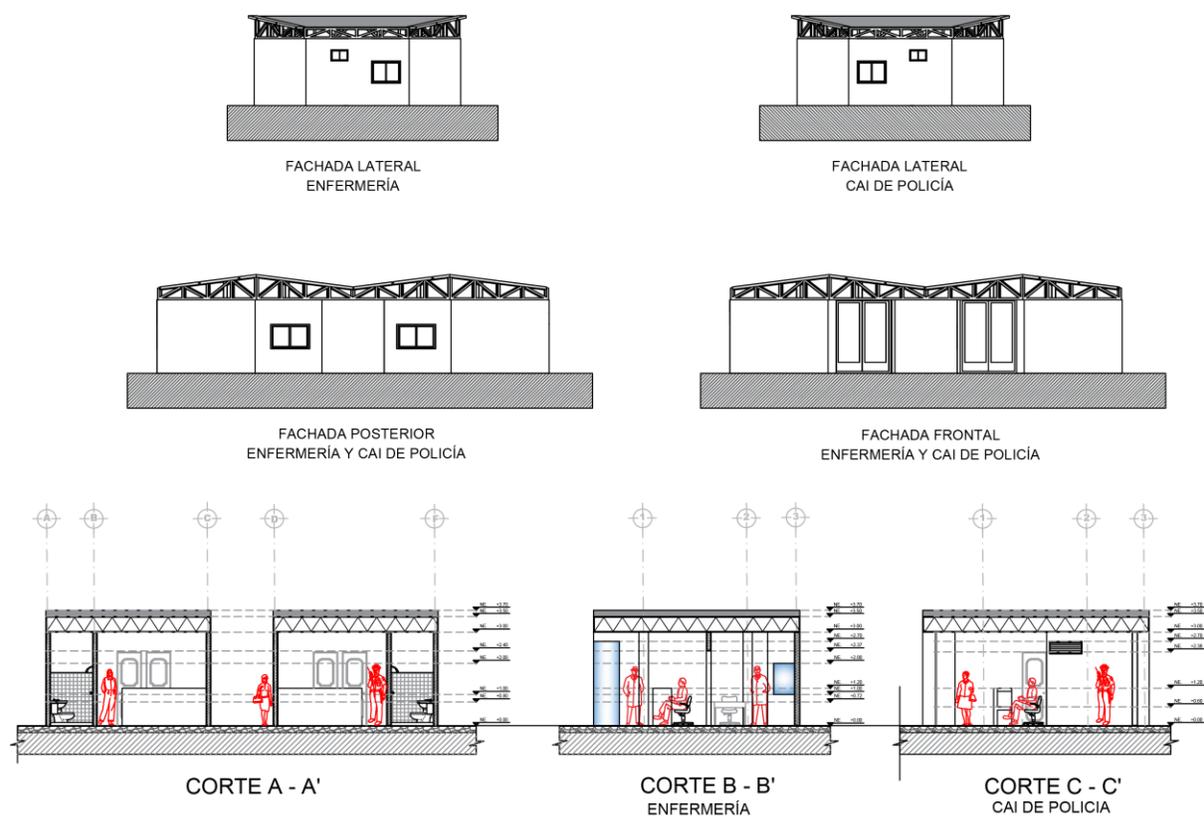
Cortes y fachadas equipamiento enfermería y cai de policía; Fuente: Elaboración propia
